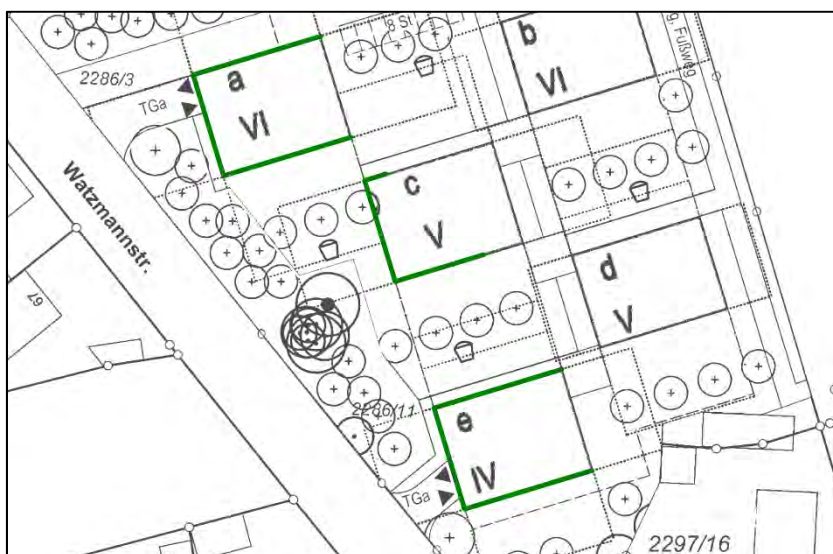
Lageplan mit Kennzeichnung der Fassaden, an denen Schallschutzmaßnahmen im 2., 3., 4. und 5. Obergeschoss erforderlich sind
